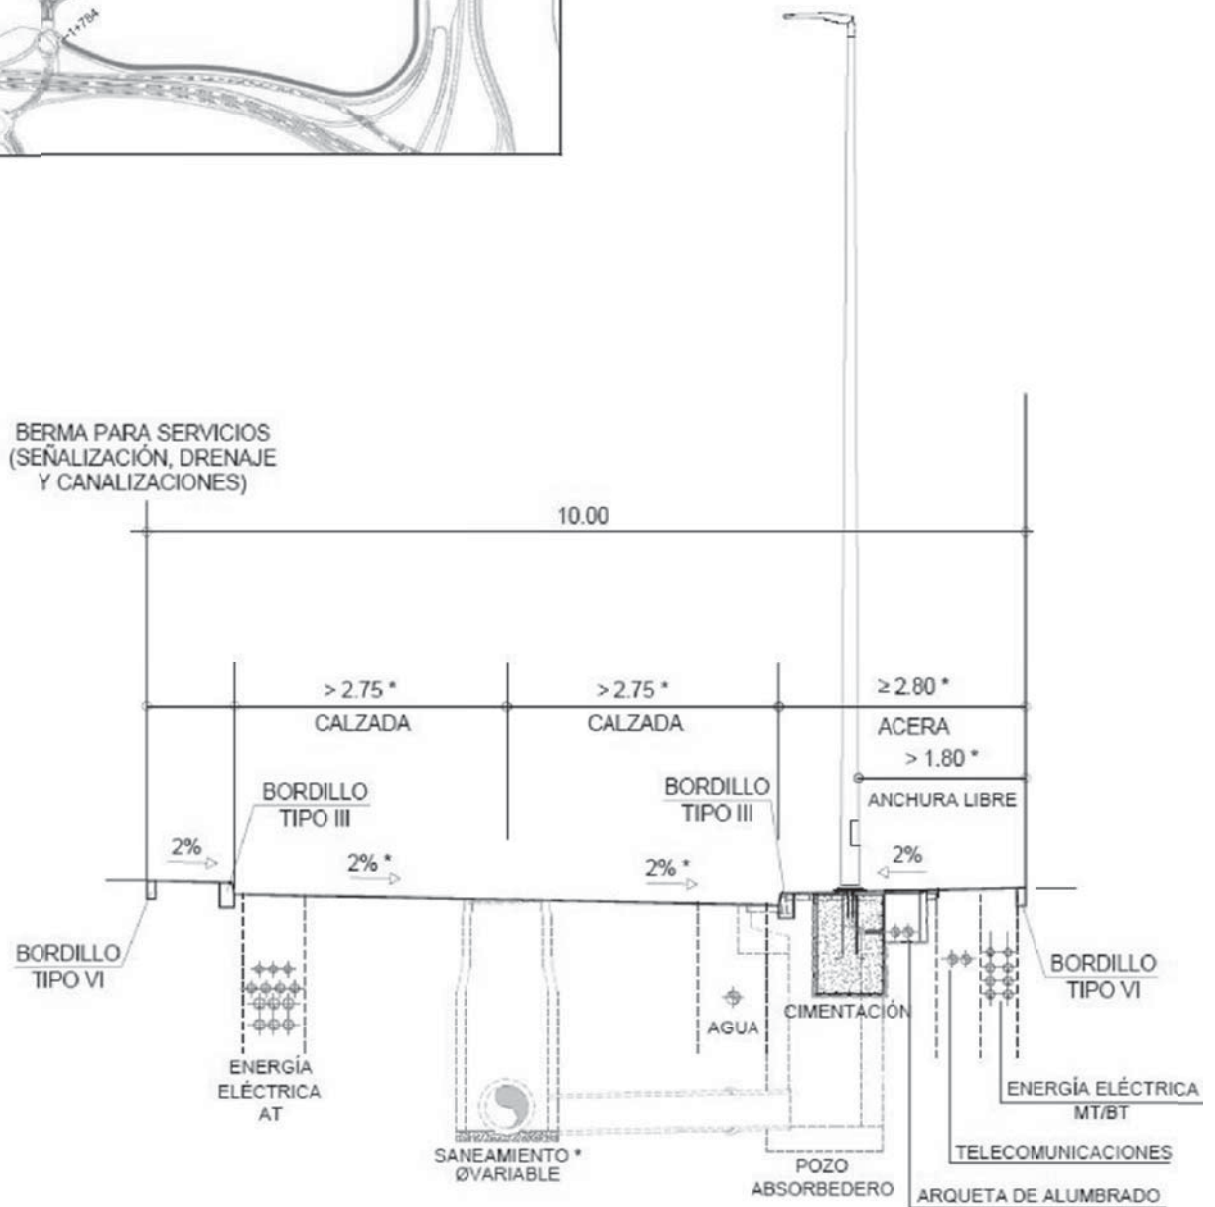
Sección Tipo del PK 160,00 – 1.784,00 (a definir en el proyecto de urbanización)
